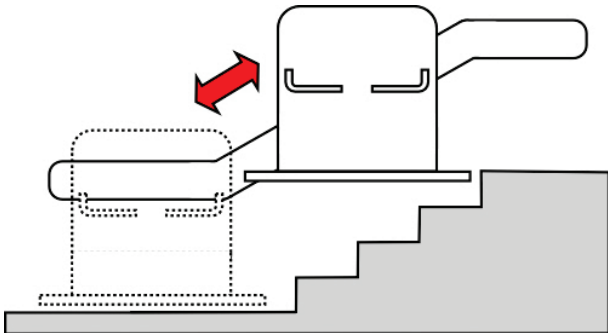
Prinzipskizze Treppenschrägaufzug mit Plattform
